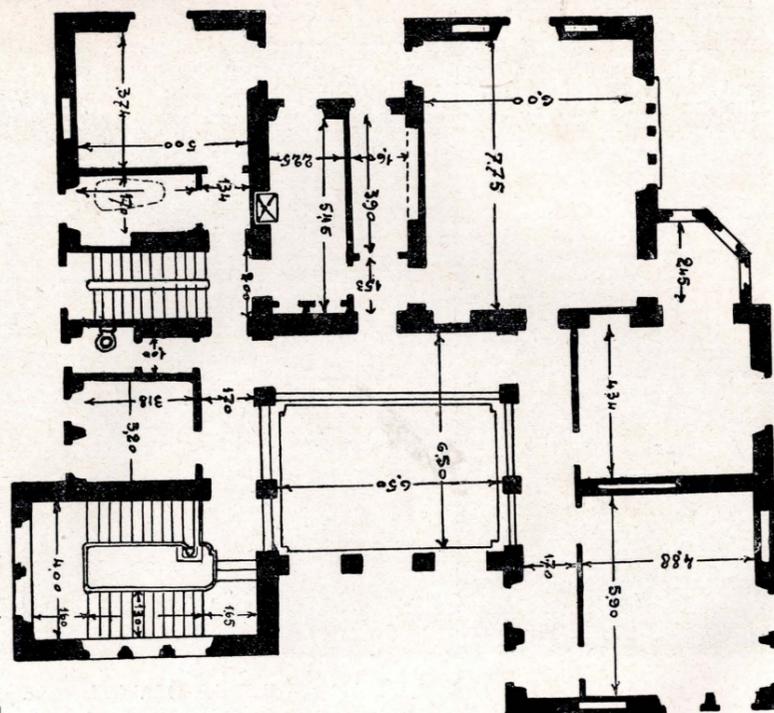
Palazzina Demichelis - Pianta del primo piano.
